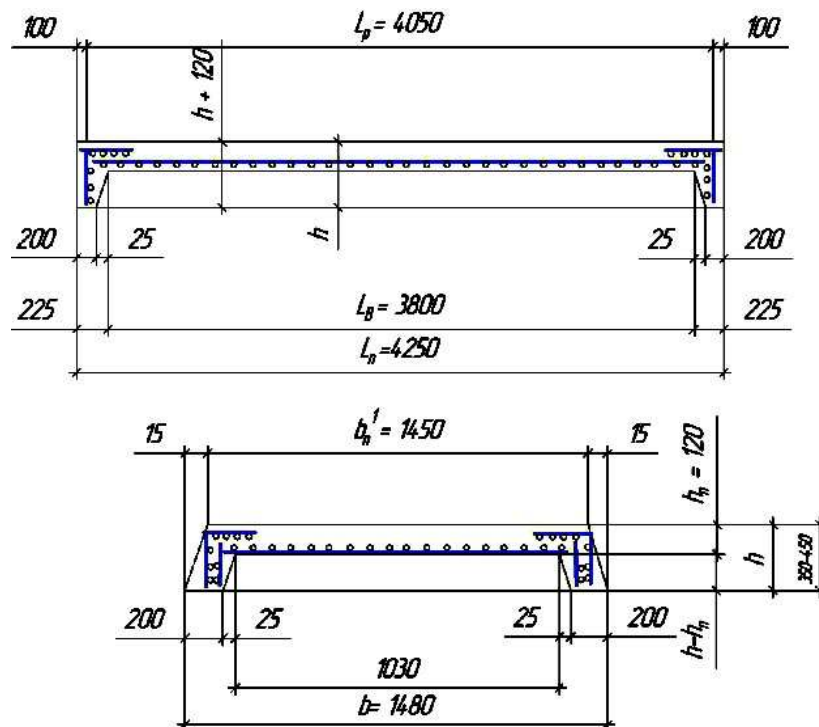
Поперечный и продольный разрезы плиты перекрытия
